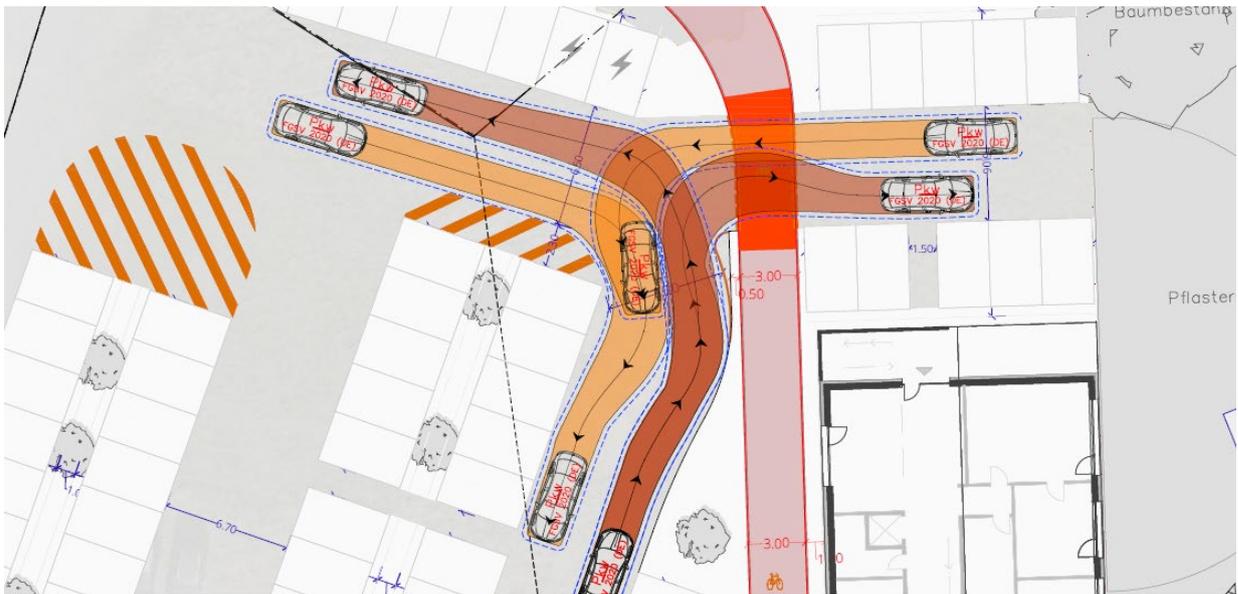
Prüfung SKP PKW, Knotenbereich Parkierungsanlage, (Architekturplan/BuP)
